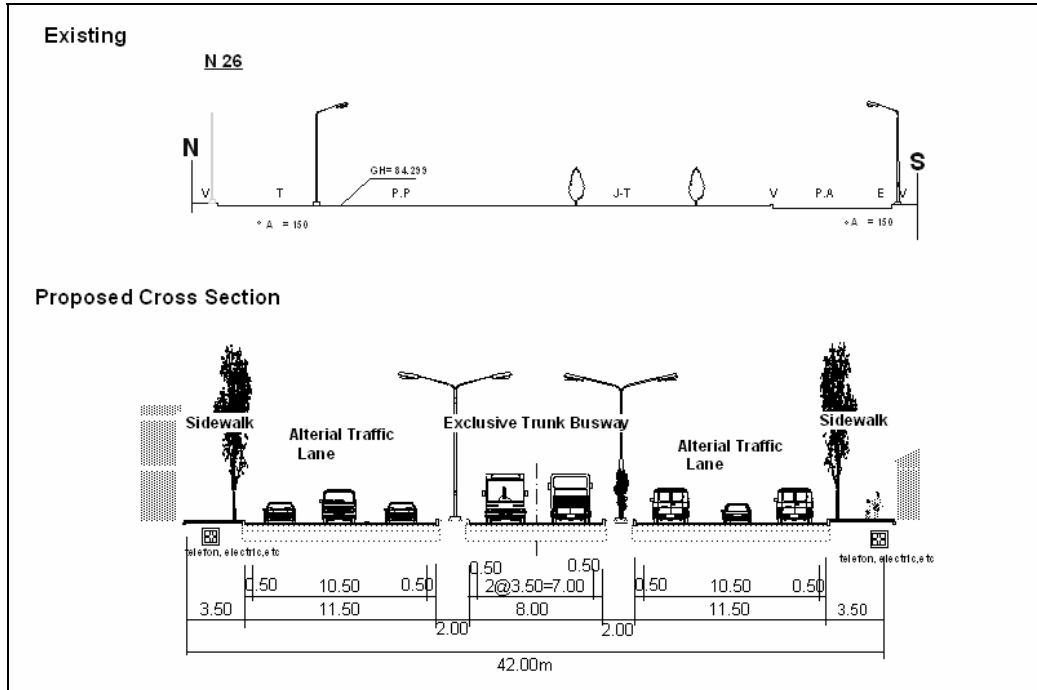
Sección Transversal Típica 42m (Tipo B)
